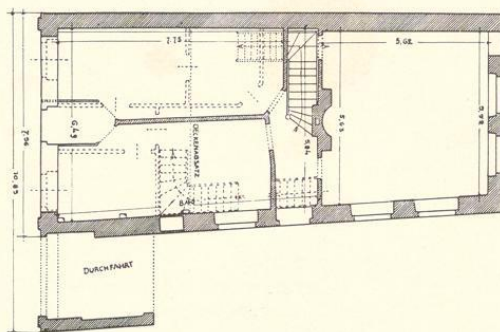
Grundriß des Hauses Neubrückenstraße 72
